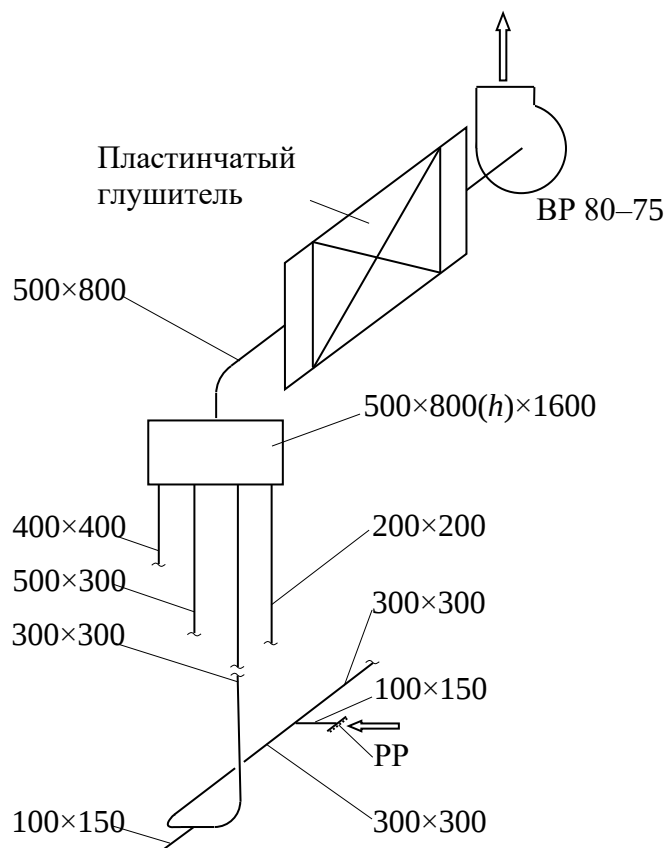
Схема вытяжной вентиляционной сети – сторона всасывания
